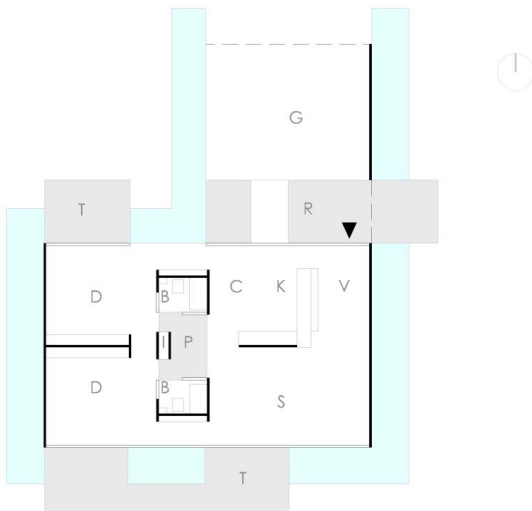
Planta de la CSH>21' de PIERRE KOENIG (1958-1959). 2010. Esguevillas, p. 226.
